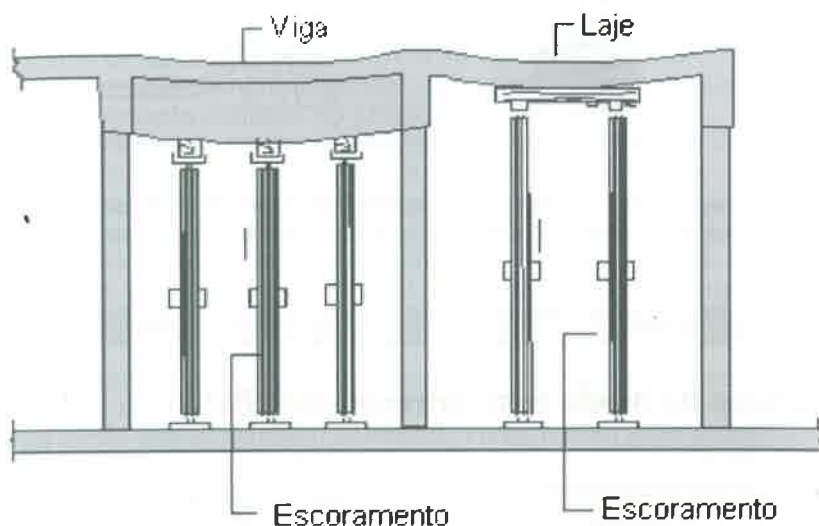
Reforço de emergência de vigas e lajes.
